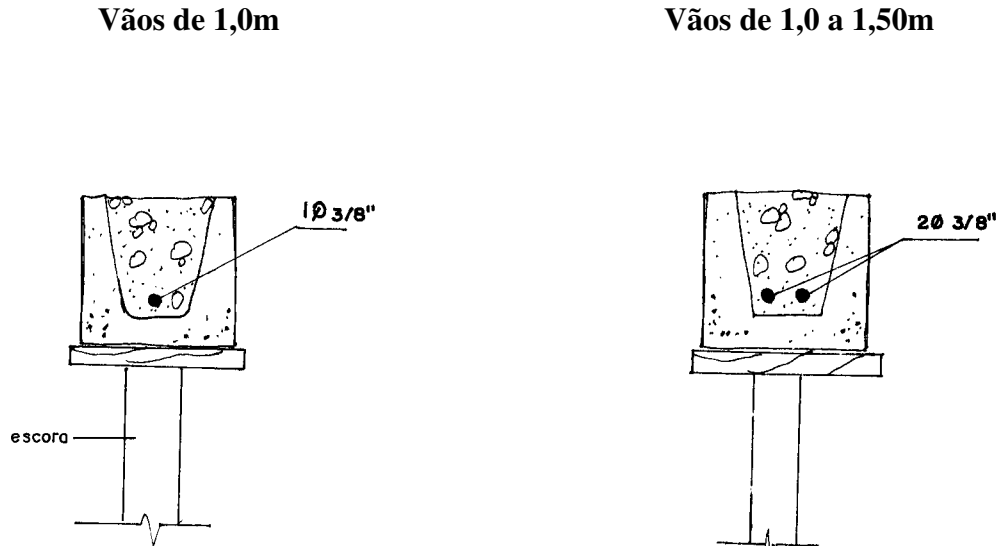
Vergas em alvenaria de bloco de concreto para vãos até 1,00m e entre 1,00m e 1,50m
